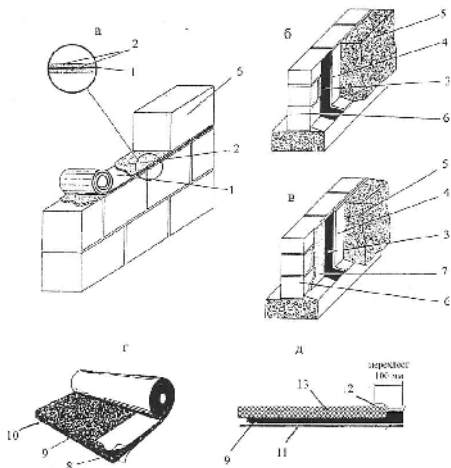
Гидроизоляция подземной части здания: а, б, в – гидроизоляция горизонтальная (а) и вертикальная (б, в); г – самоклеящиеся ленты; д – состав самоклеящейся рулонной ленты; 1 – гидроизоляционная лента, армированная стеклотканью; 2 – подкладочный и защитный слой из цементного раствора; 3 – гидроизоляционная мастика; 4 – внешний защитный и дренажный самоклеящийся материал; 5 – грунт; 6 – стена фундамента; 7 – цементный раствор; 8 – самоклеящаяся полоса по краю рулона шириной 60 мм; 9 – битумный слой; 10 – геотекстильная прокладка; 11 – защитный слой из прорезиненной бумаги; 12 – прорезиненный охранный слой
